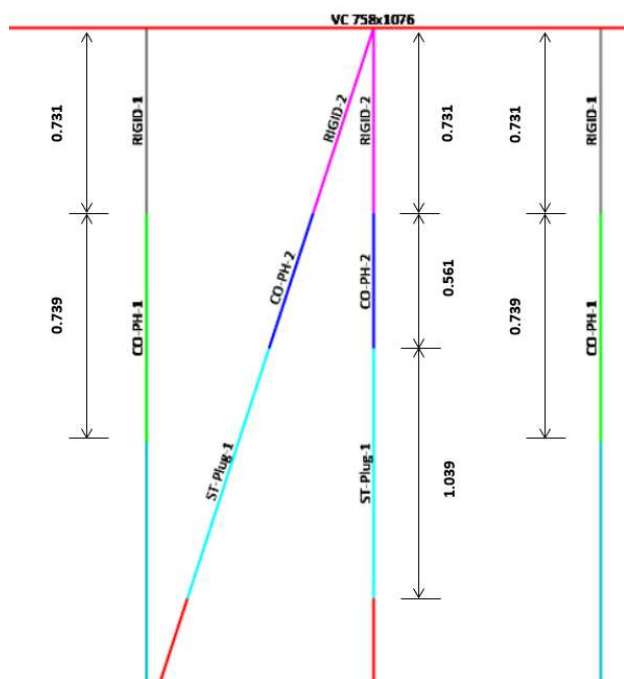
Conexión pilote-cubierta en el modelo estructural
